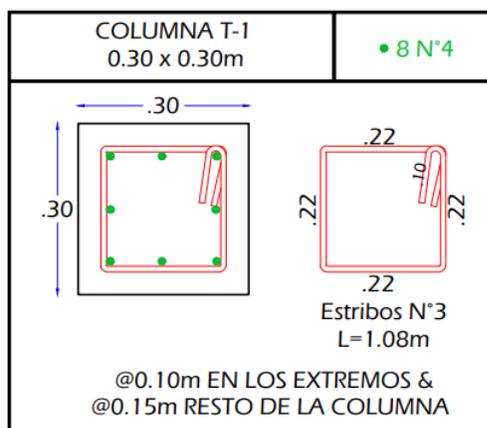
Despiece de columnas T1 nivel 4 Edificio Wiedii.
